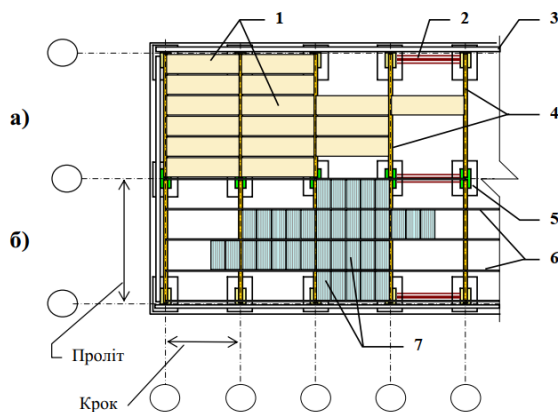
Приклади застосування безпрогонного (а) та прогонного (б) покриття: 1 – ребристі плити; 2 – вертикальний зв'язок; 3 – стіна; 4 – кроквяні несучі конструкції покриття; 5 – колона на фундаменті; 6 – прогони; 7 – профільовані сталеві листи
